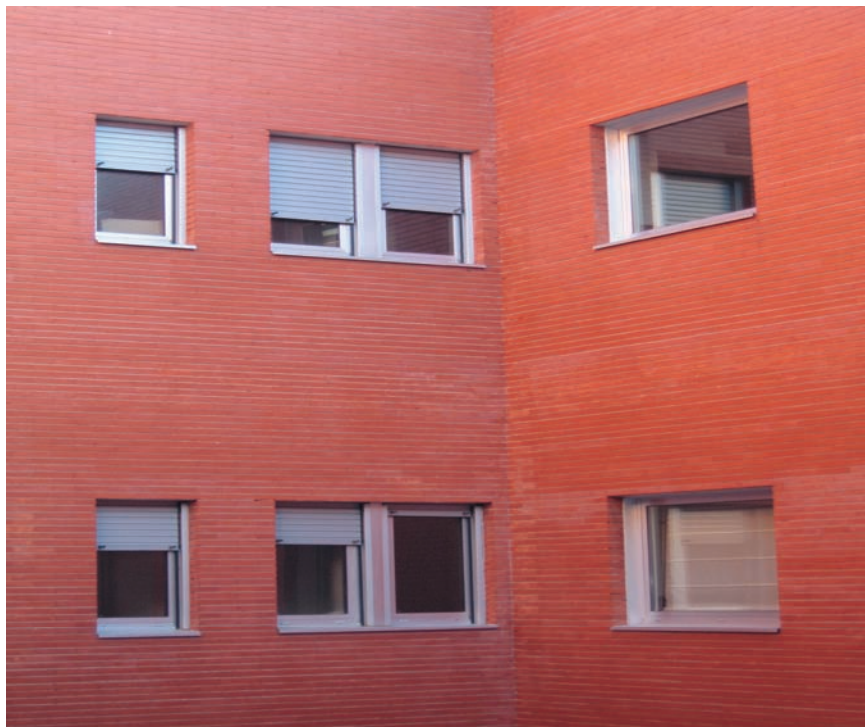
Carpintería metálica de aluminio RPT con acristalamiento banal.
